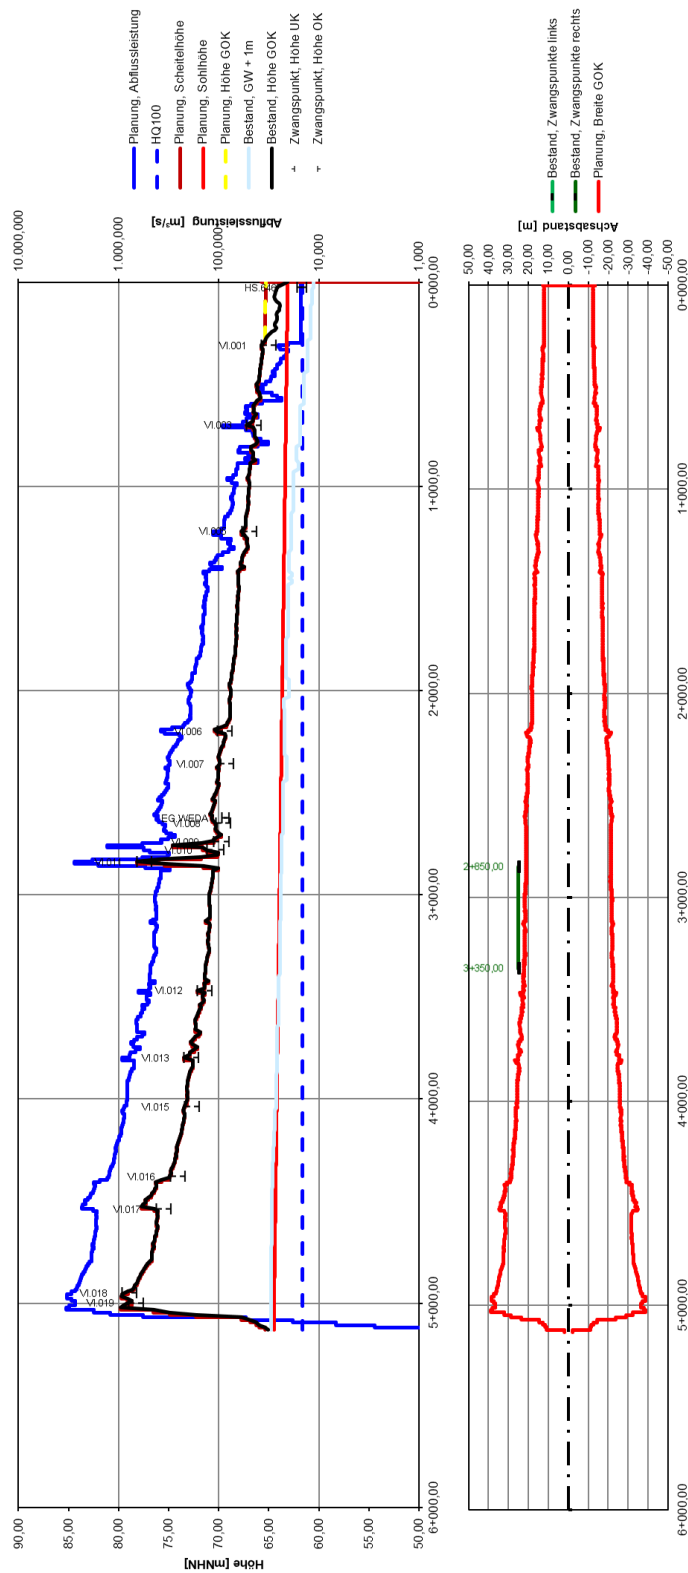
Längsschnitt (links) und Grundriss (rechts) der Variante Wiebach (3.5) (vgl. Anlage A-5.2).
